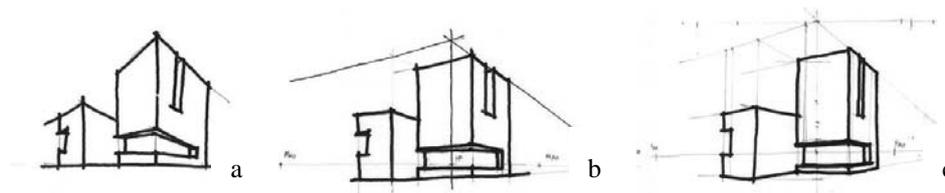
a) croqui não-estruturado, b) croqui semi-estruturado, c) croqui estruturado
